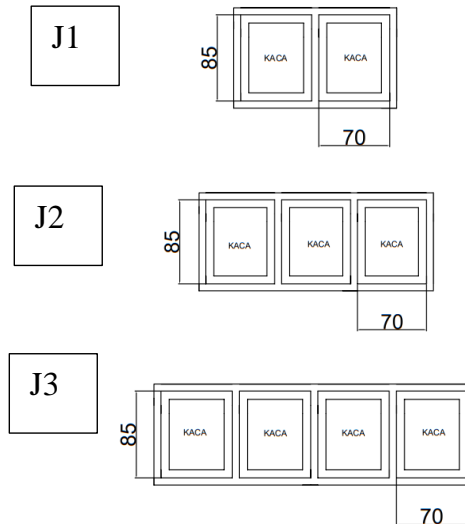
Denah Penempatan Jendela dan Ventilasi
